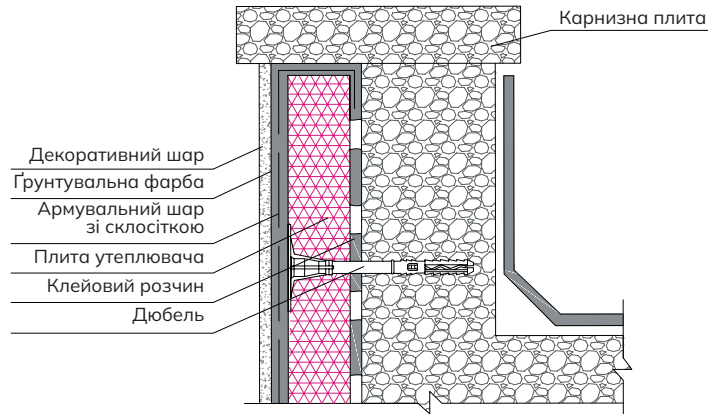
Влаштування теплоізоляції на останньому поверсі в будівлі з плоским дахом
